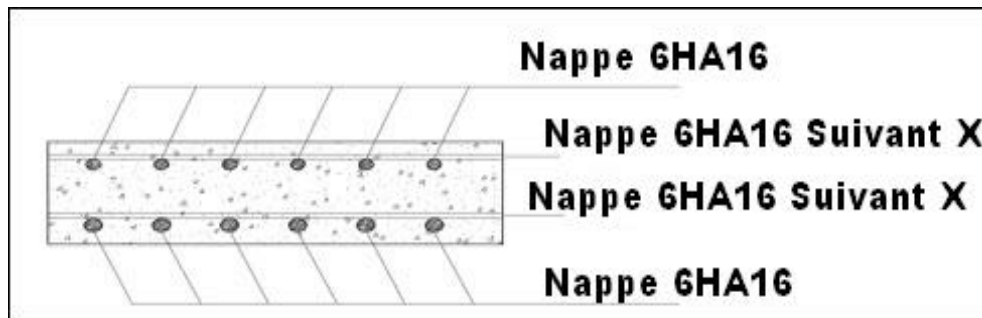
Ferrailage de la dalle dans le sens Y.
